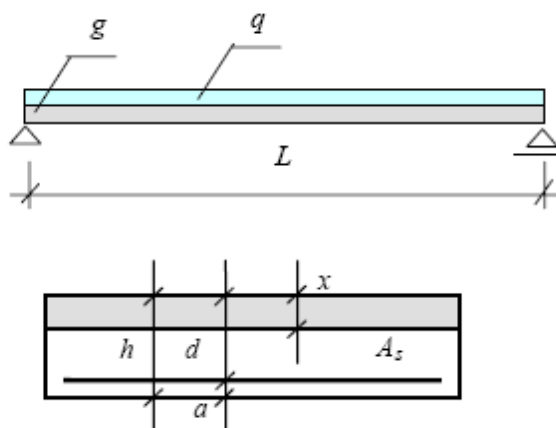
Laje simplesmente apoiada em betão armado e o seu alçado e corte transversal, (JCSS, 2001).
